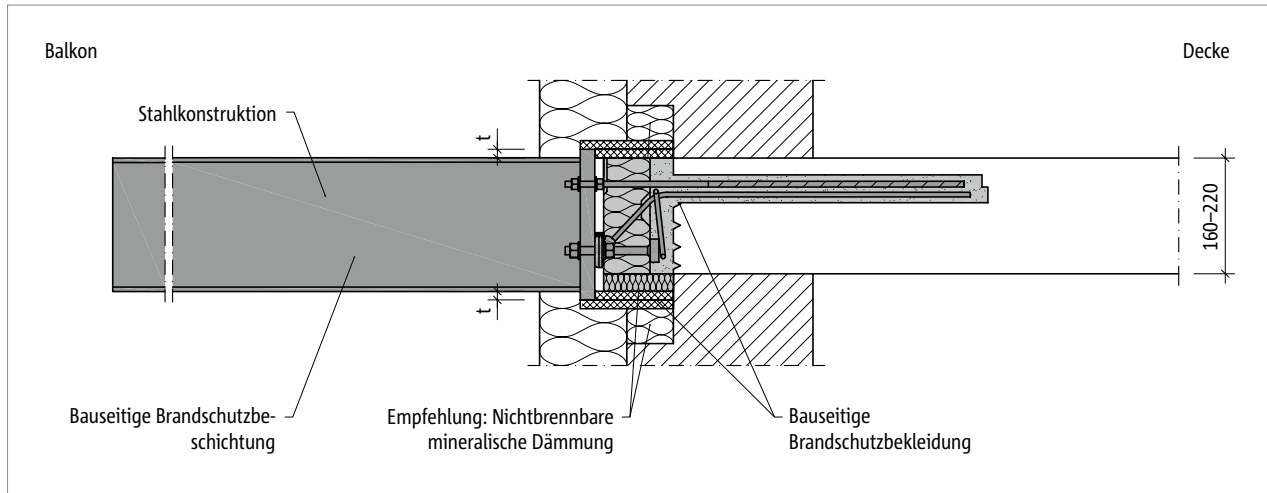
Schöck Isokorb® RT Typ SK: Bauseitige Brandschutzbekleidung RT Typ SK und brandschutzbeschichtete Stahlkonstruktion; Schnitt
